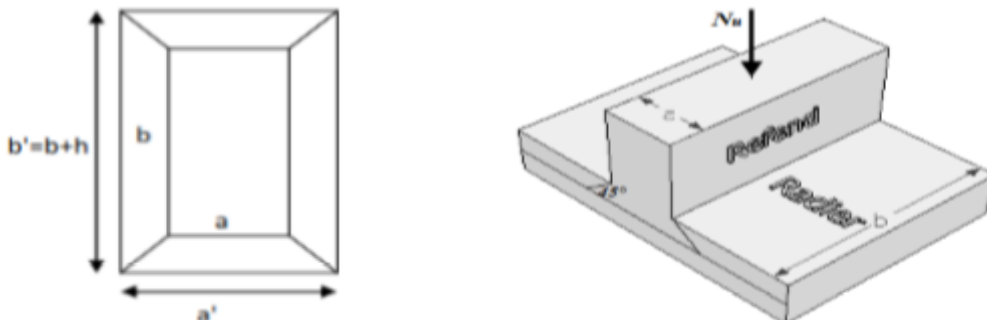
Périmètre utile des voiles et des poteaux.
